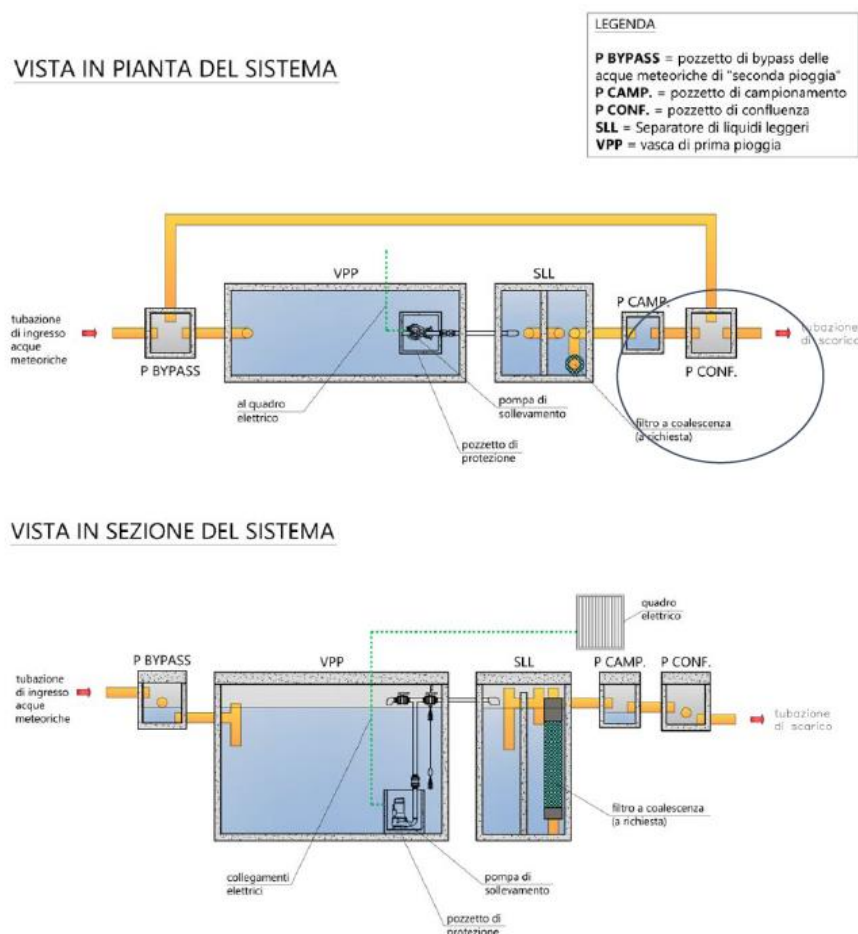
Vista in pianta e in sezione del sistema di trattamento delle acque di prima pioggia
